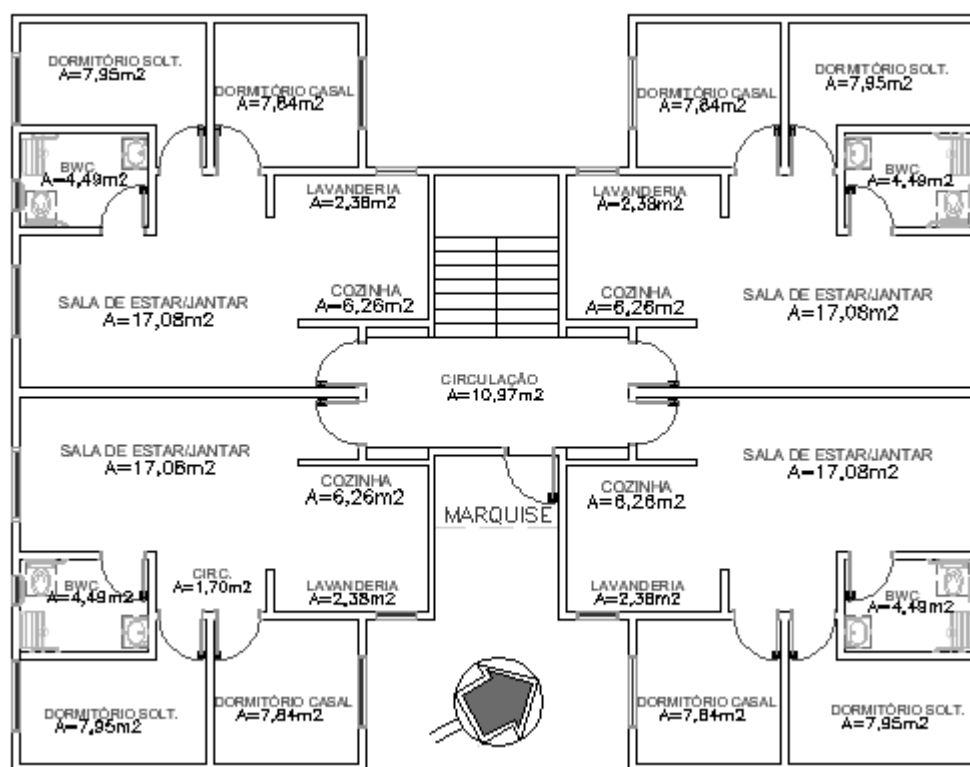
Planta baixa do pavimento térreo do Bloco 3 (ap. adaptáveis)
